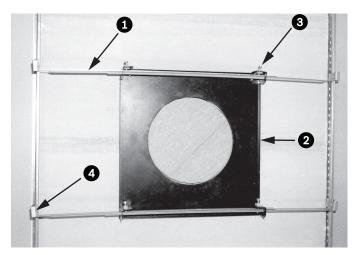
Support pour suspension au plafond (vue supérieure)
